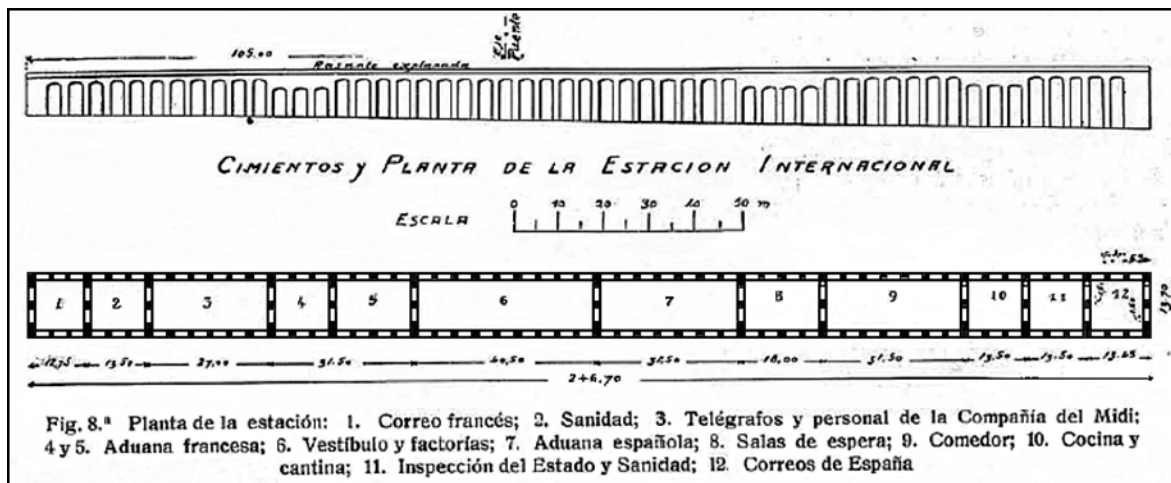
Plano de los cimientos y planta del Edificio de Servicio, extraído de revista Ibérica, Tortosa, n^o 287 - 288, 19 - 26 - VII - 1919, p. 75. El plano es una simplificación hecha por Caballero de Rodas con arreglo al boceto que realizó Ramírez de Dampierre, en marzo de 1918 y en enero de 1919, ya de forma definitiva. Este último se adjunta en el Anexo IV.
